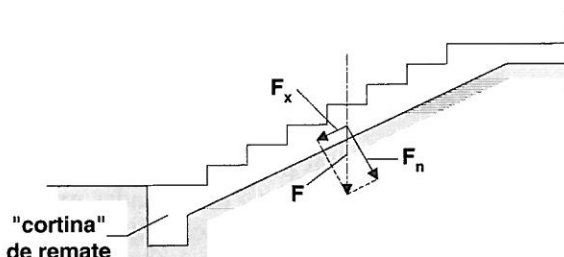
Corte longitudinal da escada apoiada no solo.
